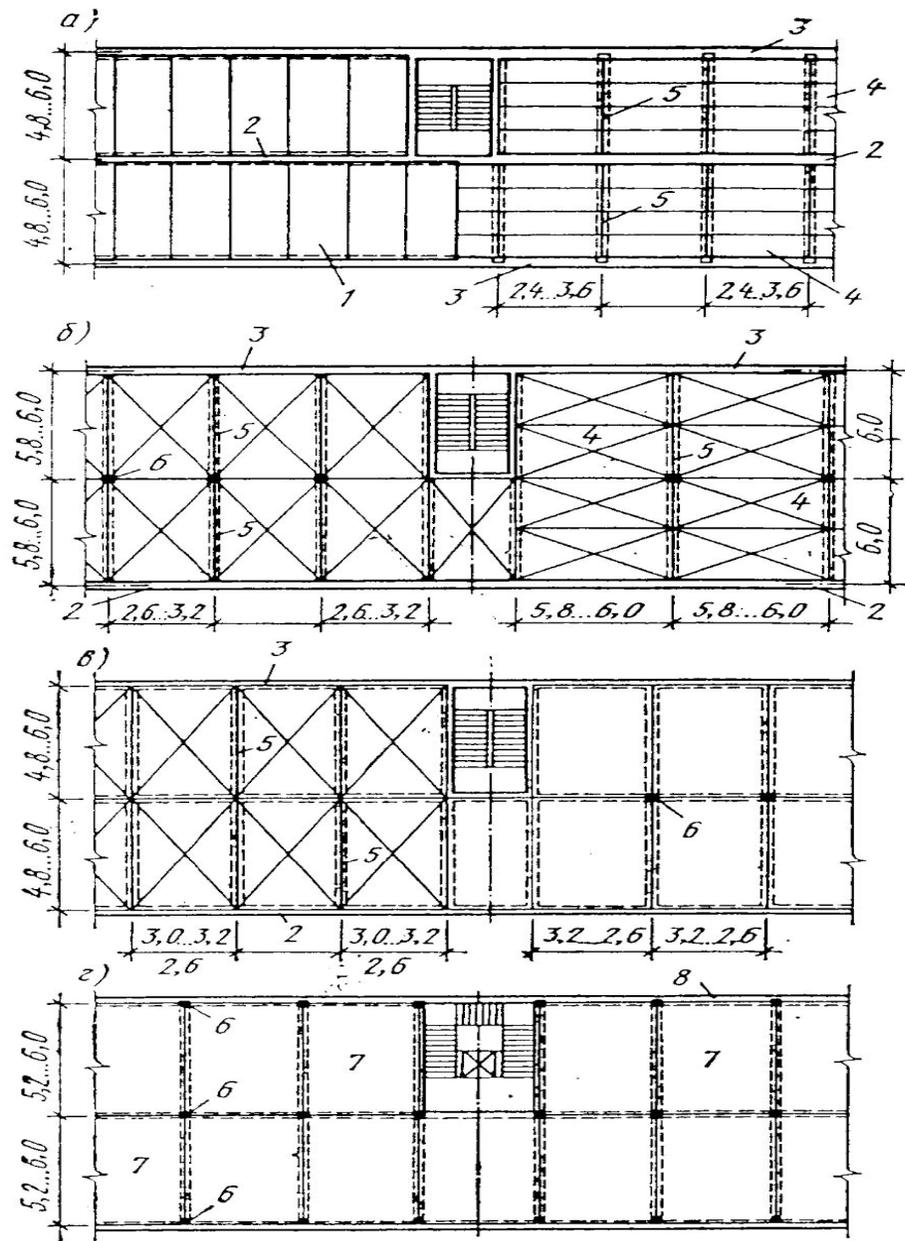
Конструктивные схемы плитных перекрытий:
